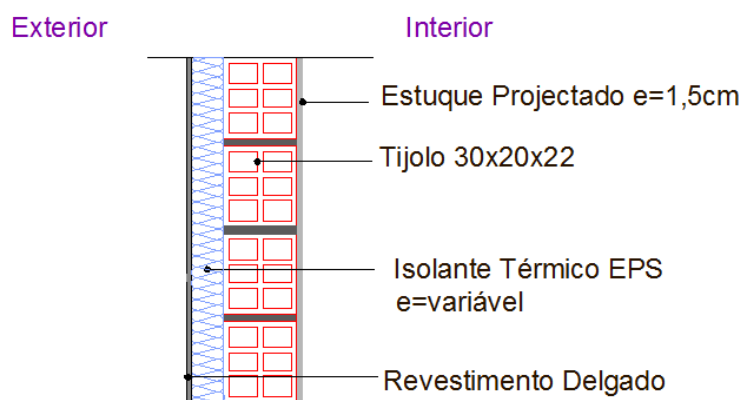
Pormenor construtivo do sistema ETICS em zona corrente
